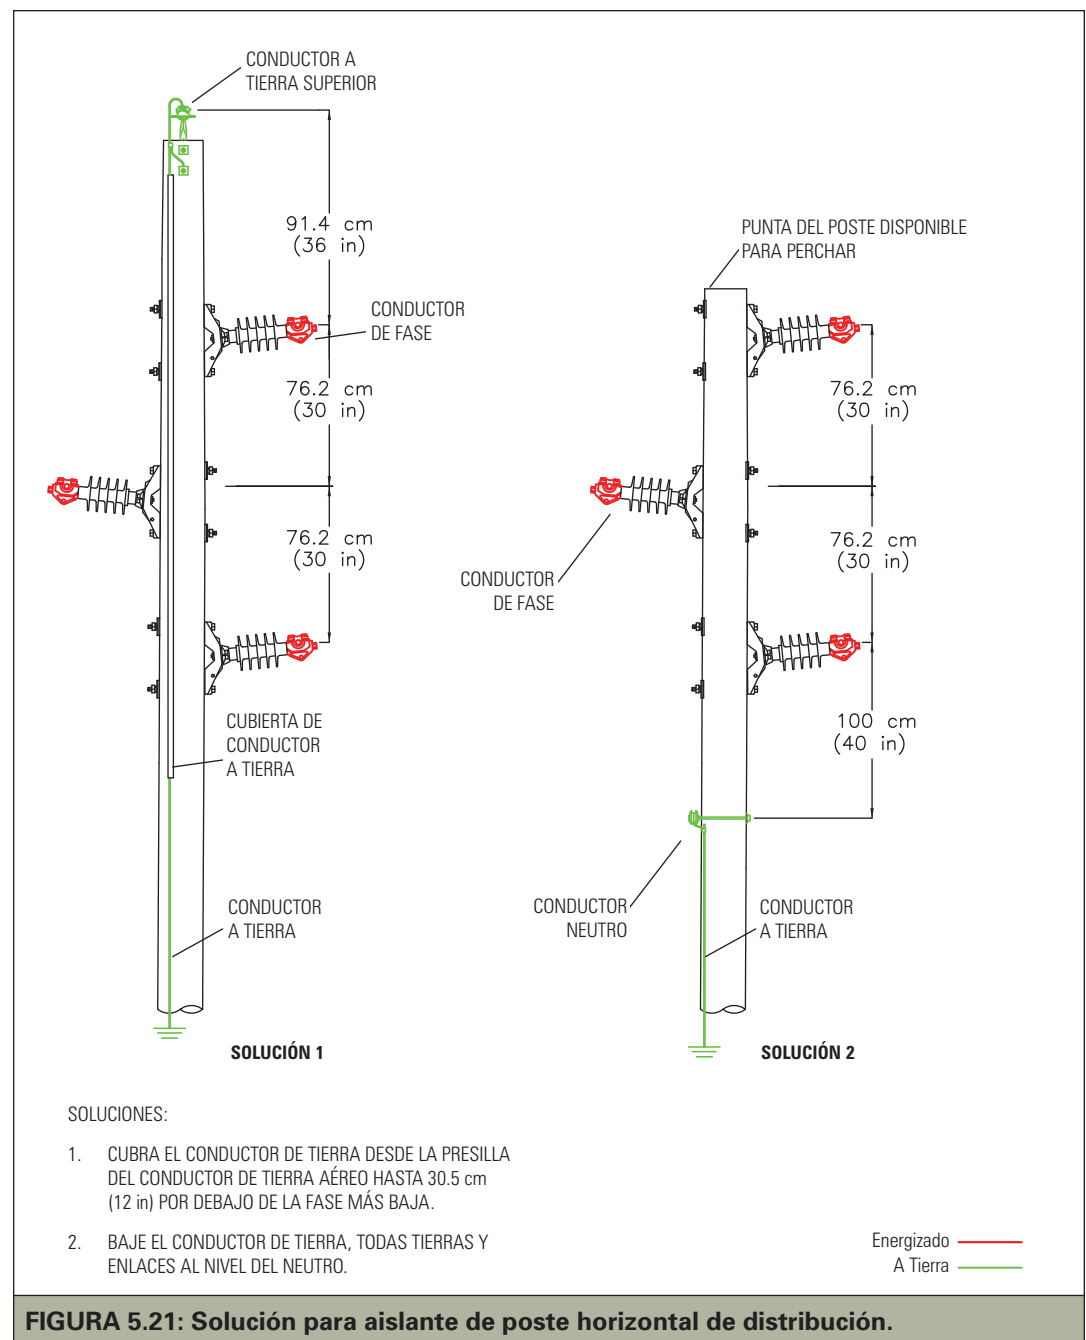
Solución para aislante de poste horizontal de distribución.
